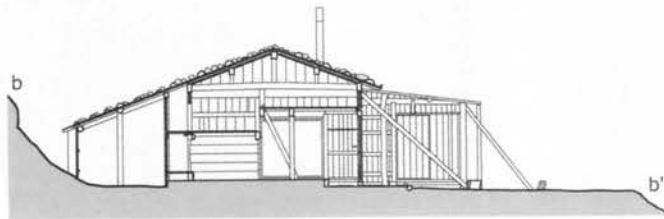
徳本峠小屋 b-b' 断面図 (S=1/200)
